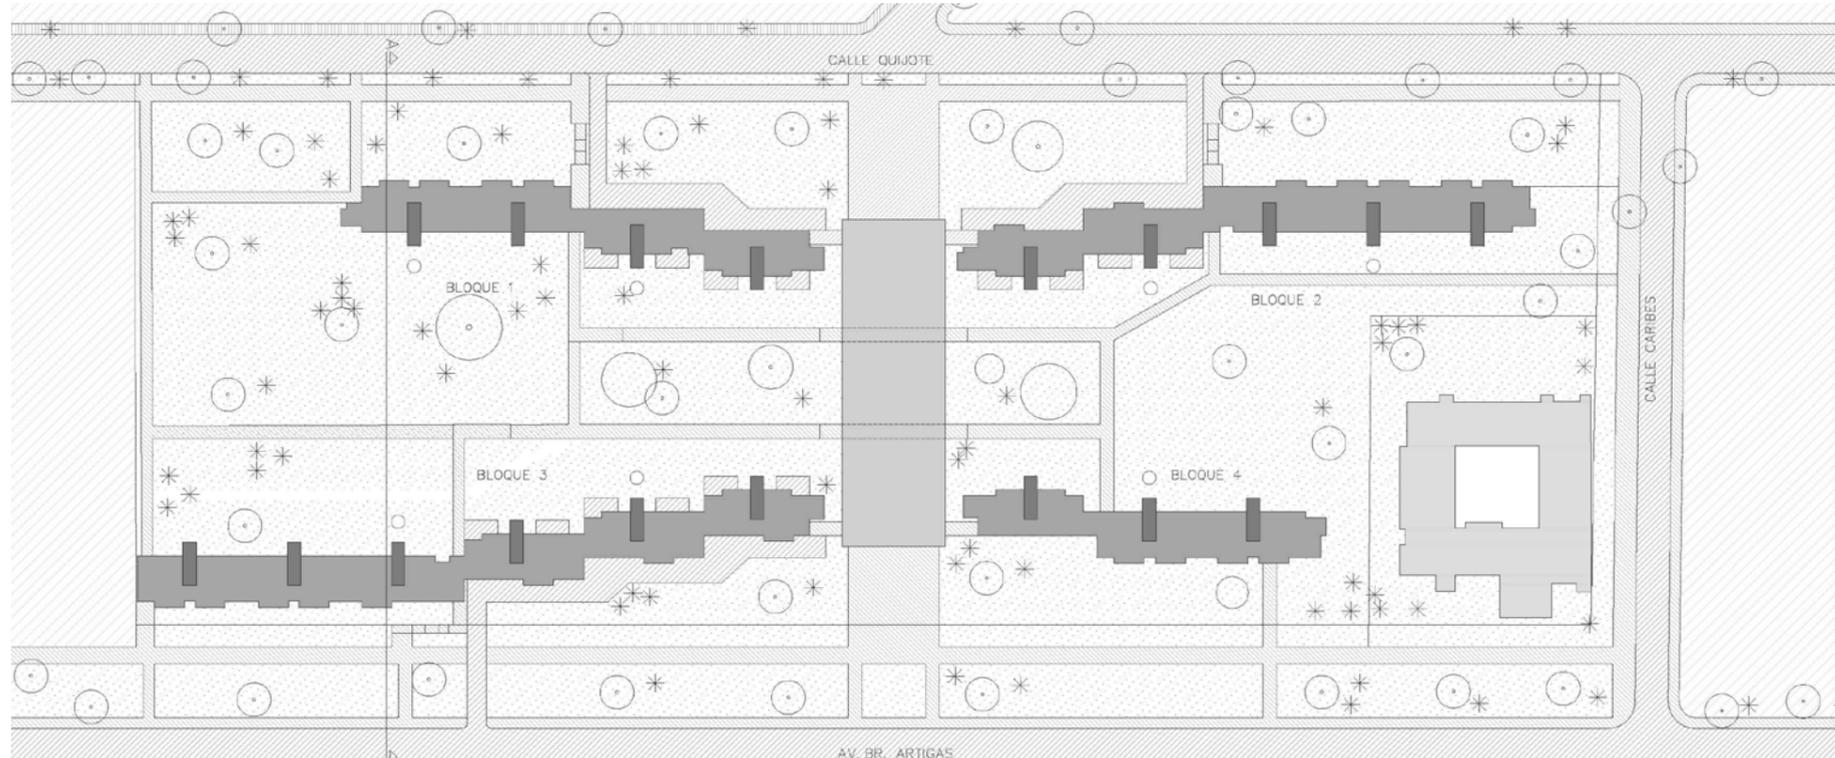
, Planimetría de conjunto Habitacional Artigas recuperado desde <https://nomada.uy/guide/view/attractions/4293>
